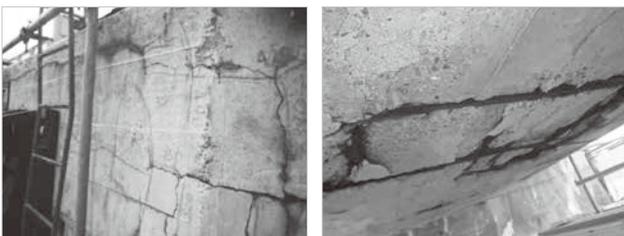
劣化状況（ひび割れ、鉄筋露出）
